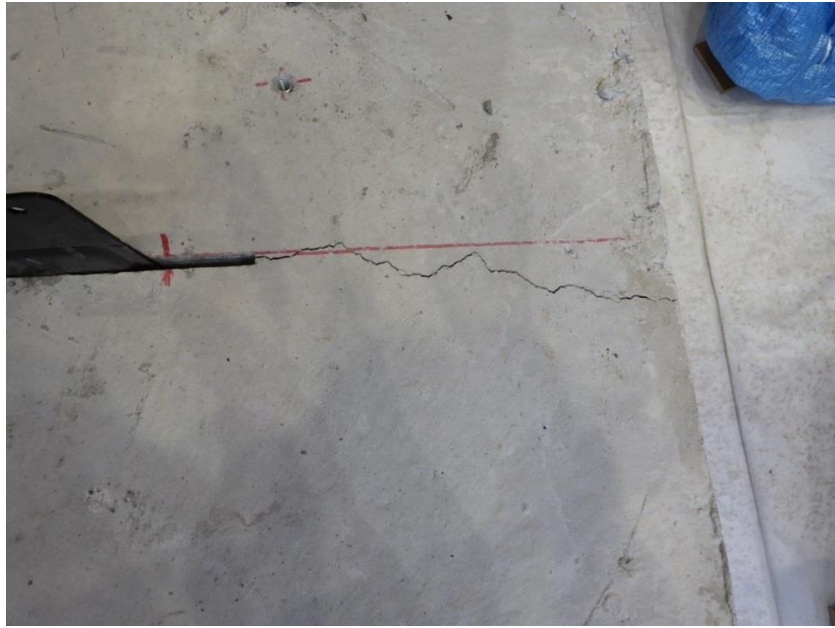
試験体①のひび割れ発生状況 (2/3)
